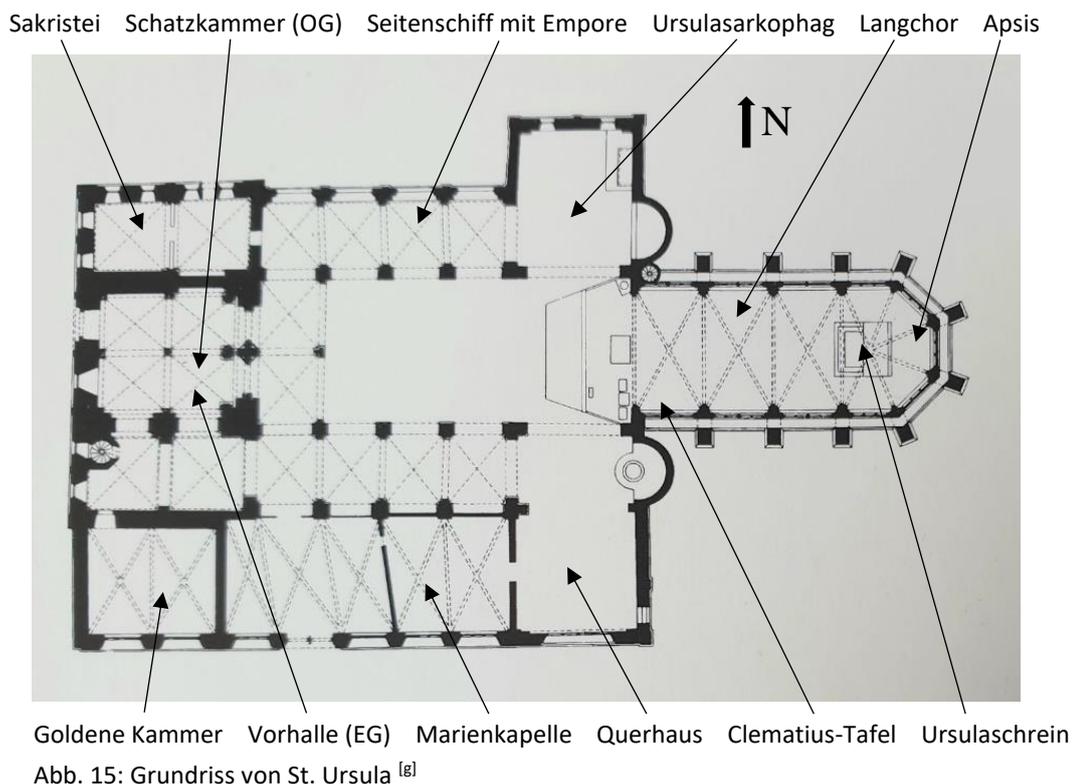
Grundriss von St. Ursula ^[8]
